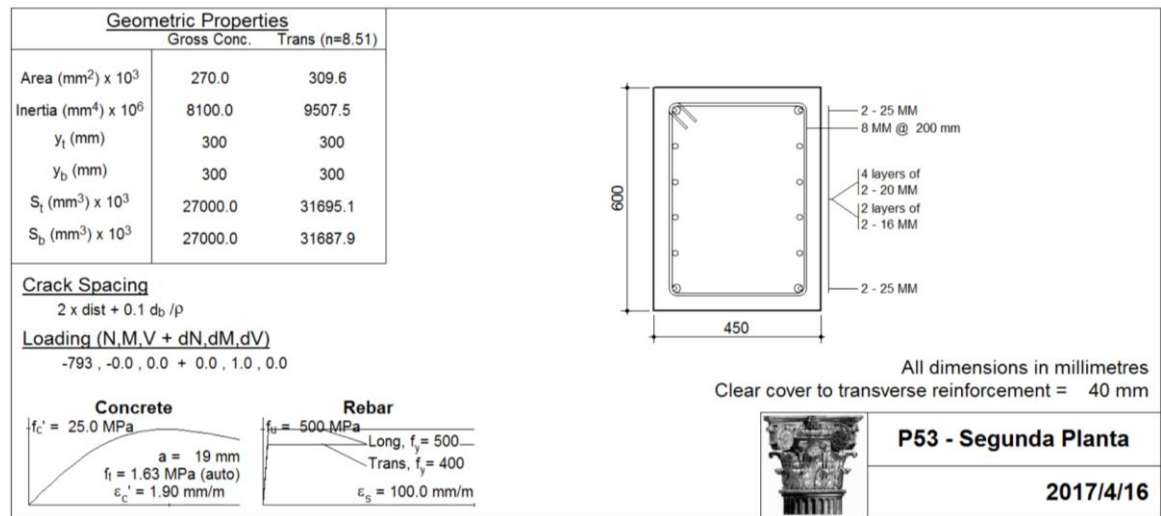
Datos del pilar 53 en segunda planta (Ref. [6])
